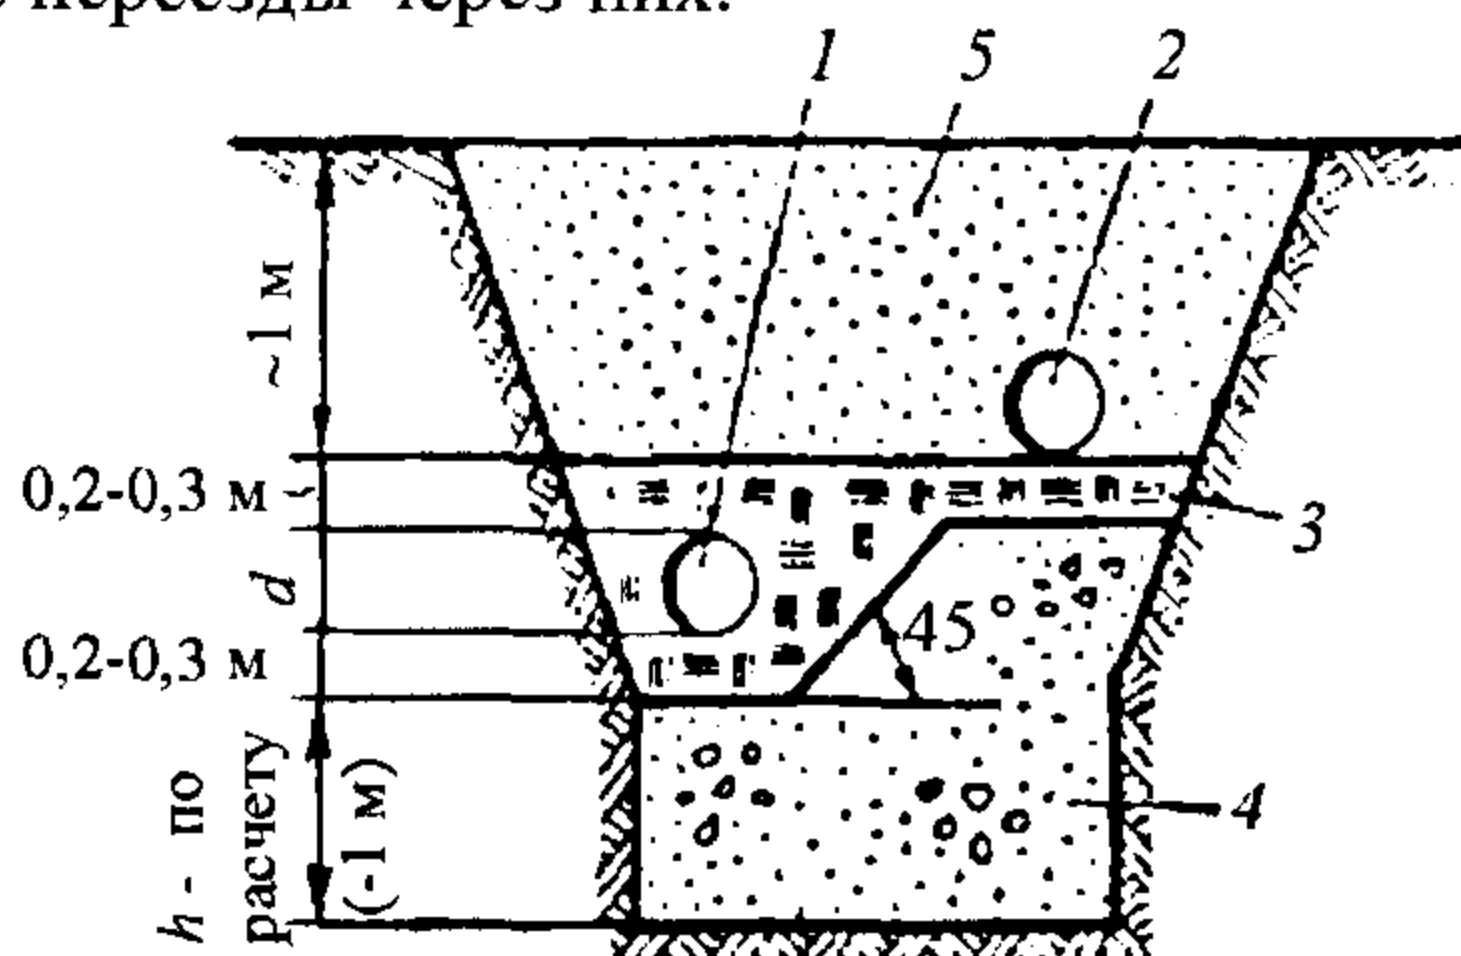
Совмещенная прокладка трубопроводов сетей водоснабжения и водоотведения в грунте:
